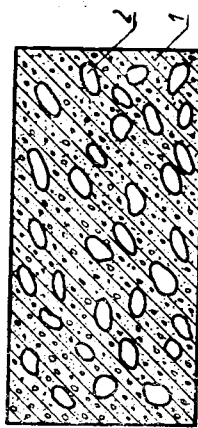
Beton celular: 1 — beton; 2 — pori.
